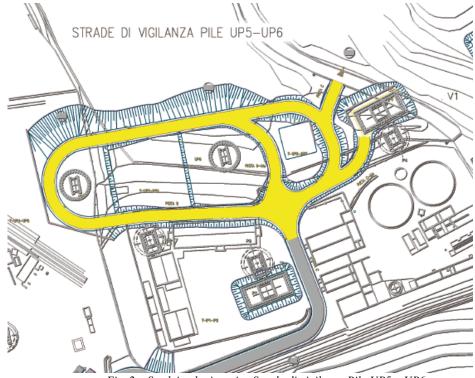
Stralcio planimetrico Strada di vigilanza Pile UP5 – UP6
